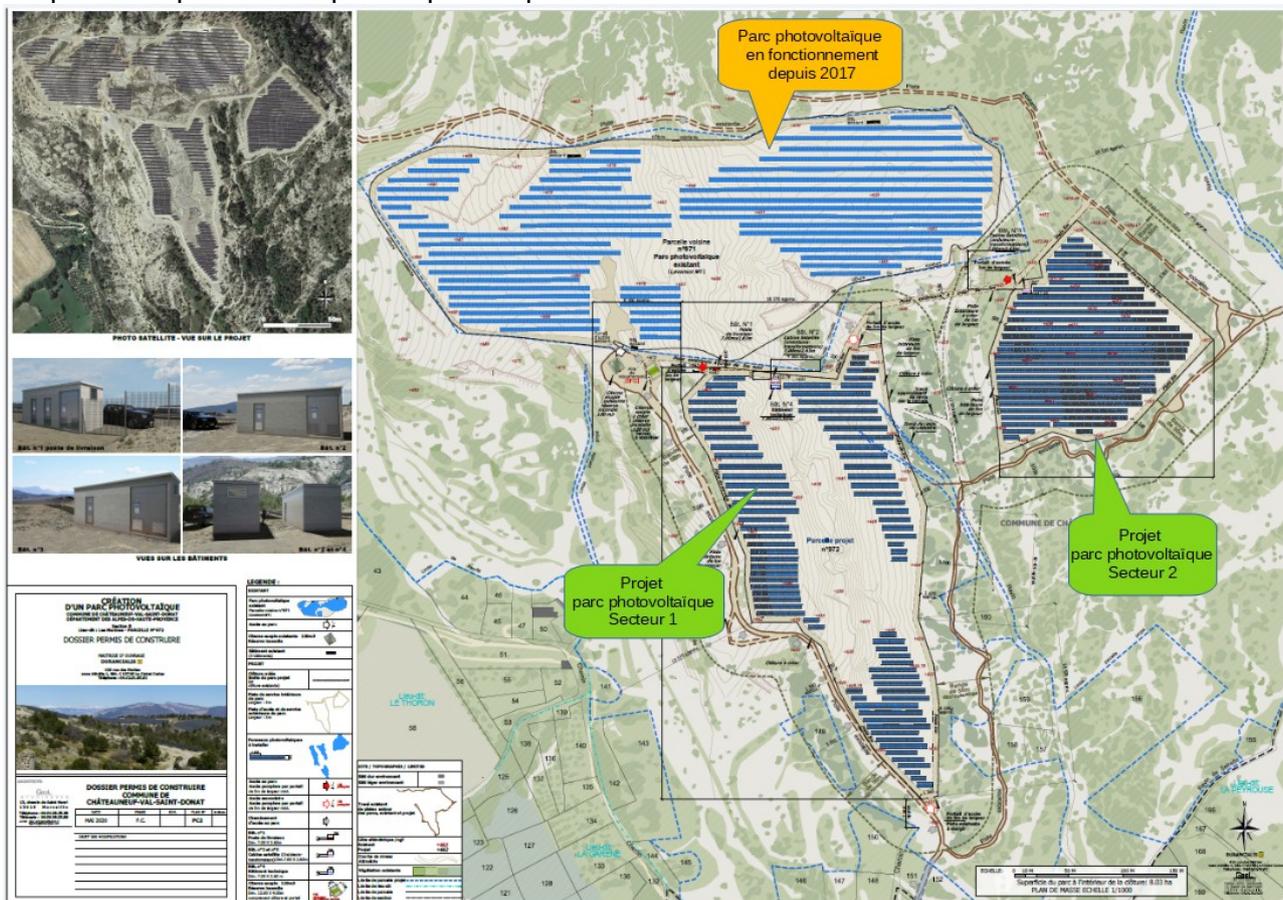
Plan de masse du site en projet et parc PV existant - source : étude d'impact
